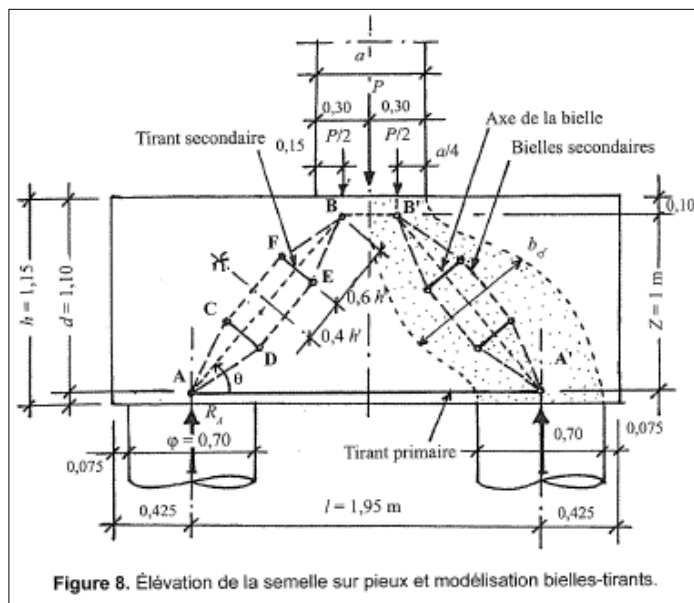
Élévation de la semelle sur pieux et modélisation bielles-tirants.
